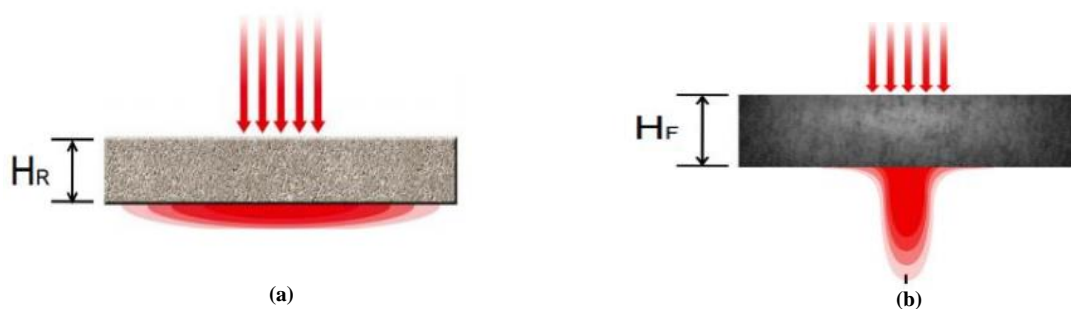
Distribuição de carga em pavimento rígido (a) e no pavimento flexível (b)
